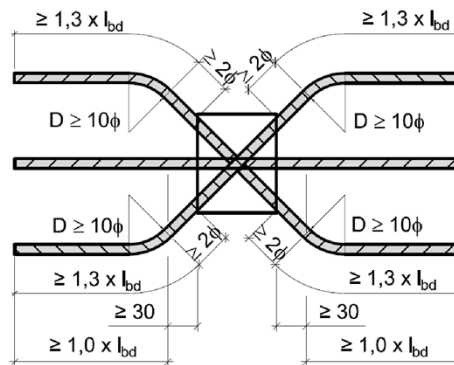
Horizontalstäbe geneigt und gerade für Schöck Isokorb® Typ H-VV-NN, Aufsicht
